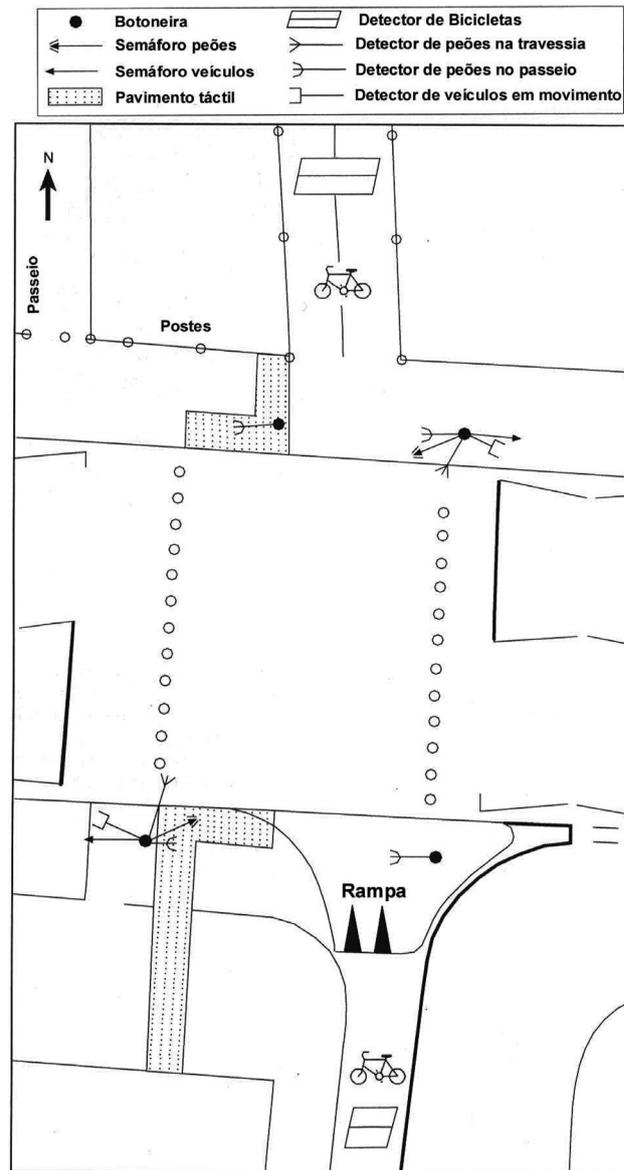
Planta esquemática de atravessamento do tipo "Toucan" (fonte: Ryley et al., 1998)
